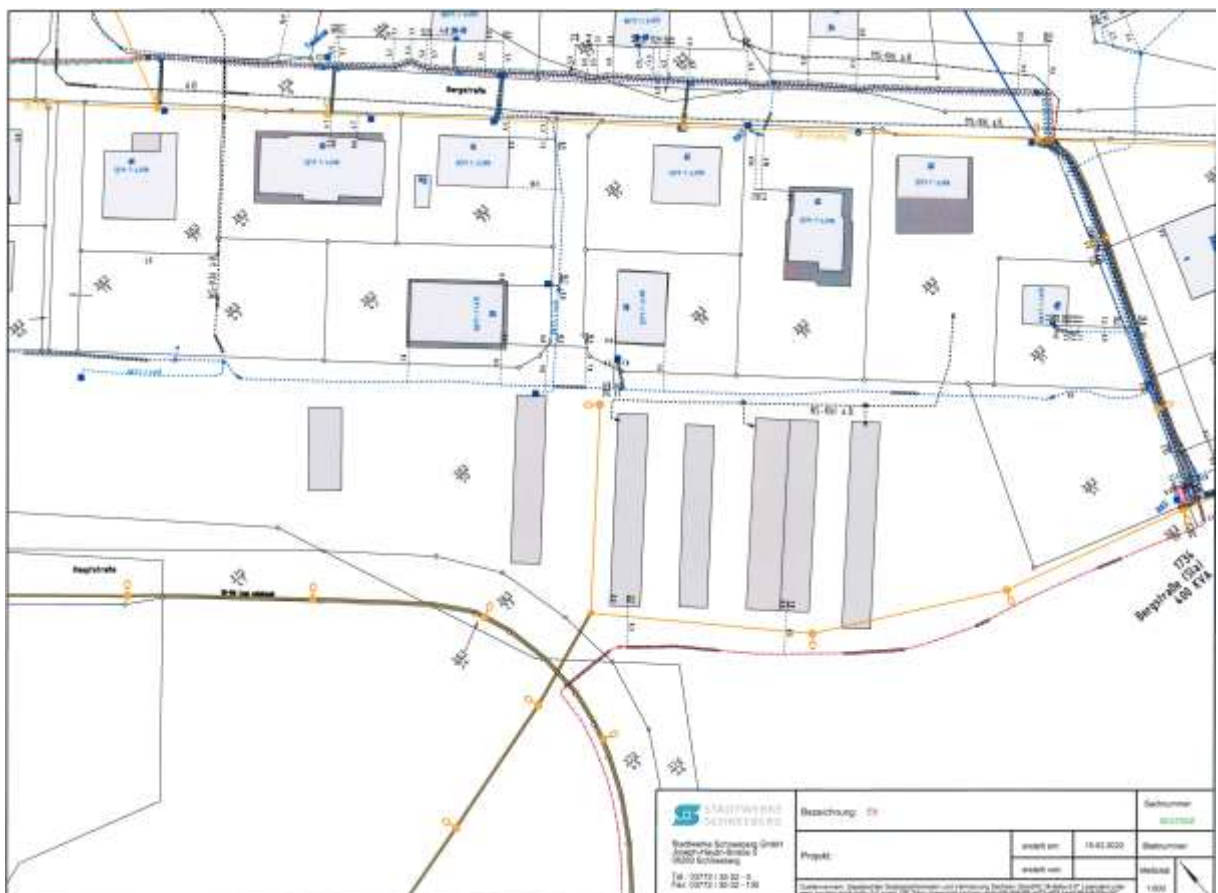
Lageplan Elektroenergie Stadtwerke Schneeberg GmbH [6]
